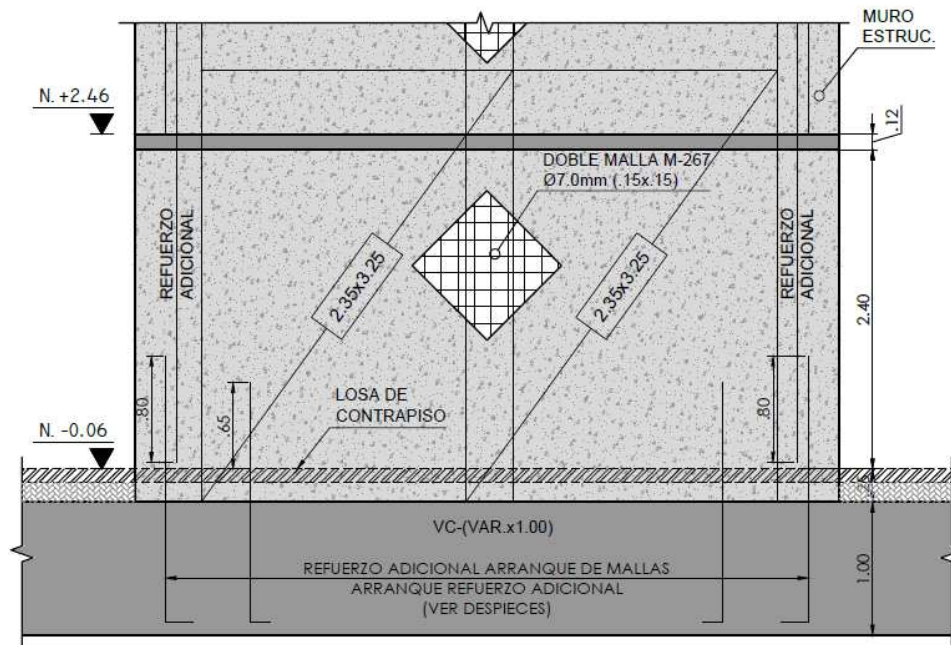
Detalle típico conexión de muros al sistema de cimentación. Fuente: Imágenes de planos DUAL INGENIERÍA ESTRUCTURAL SAS. Archivo personal, recuperado en el 2017.
